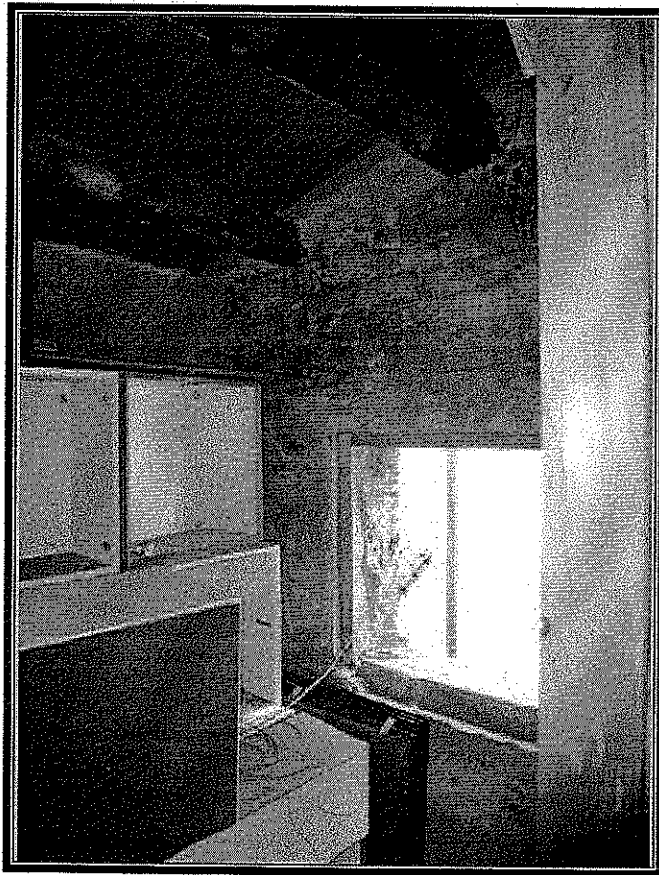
terrazzo – 1<sup>^</sup> piano
